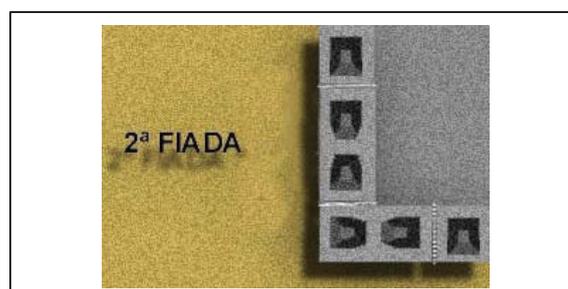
Amarração de Painéis com Armadura – 2ª Fiada
